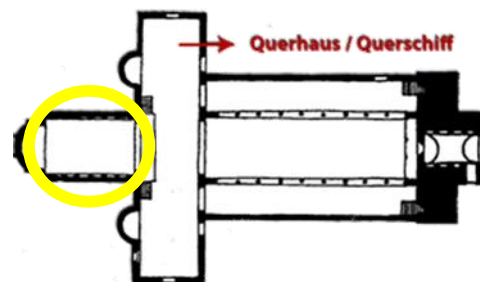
Abb.V: Grundriss mit eingefügtem Chor => lateinisches Kreuz
